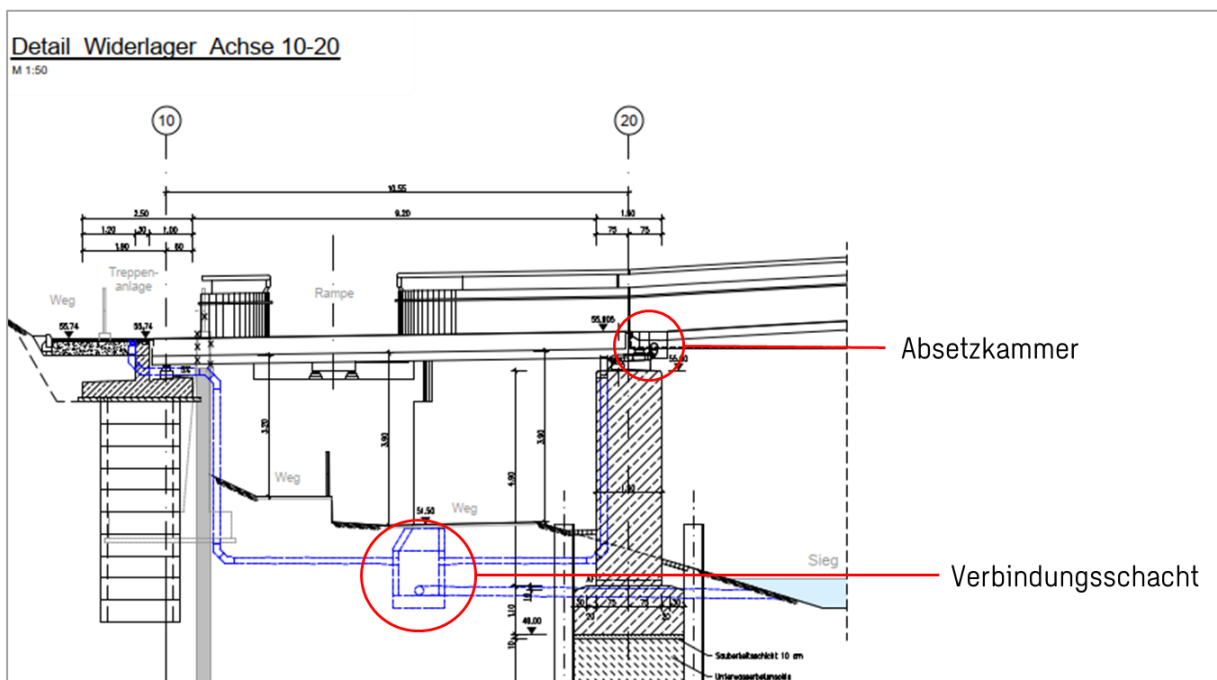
Detail Widerlager Achse 10-20, angepasst aus Planfeststellung Brücke Schnitte und Details [8]
